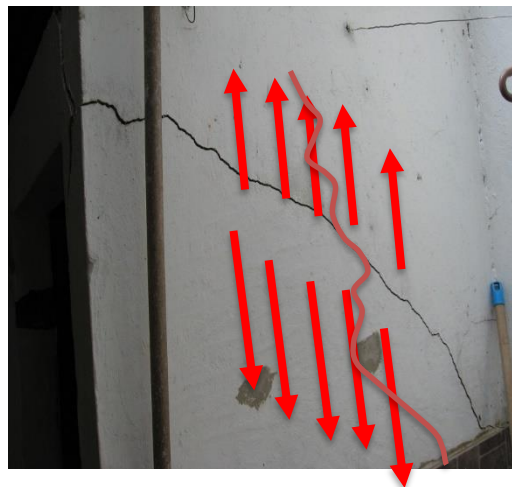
Grieta en muro provocado por elementos estructurales mal conecta.
